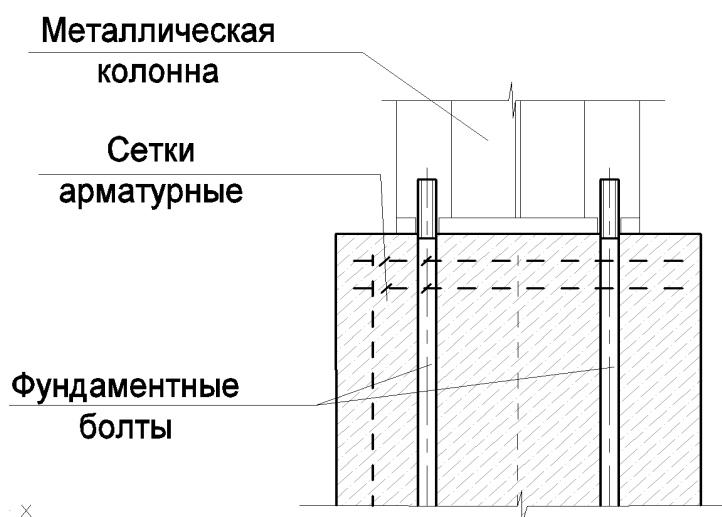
Конструкция стыка фундамента с металлической колонной
